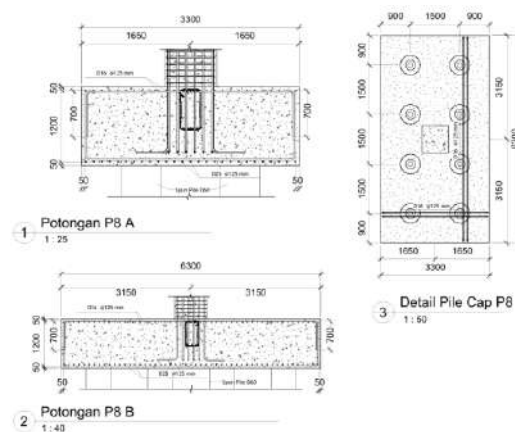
29 Potongan dan Detail *Pile Cap
